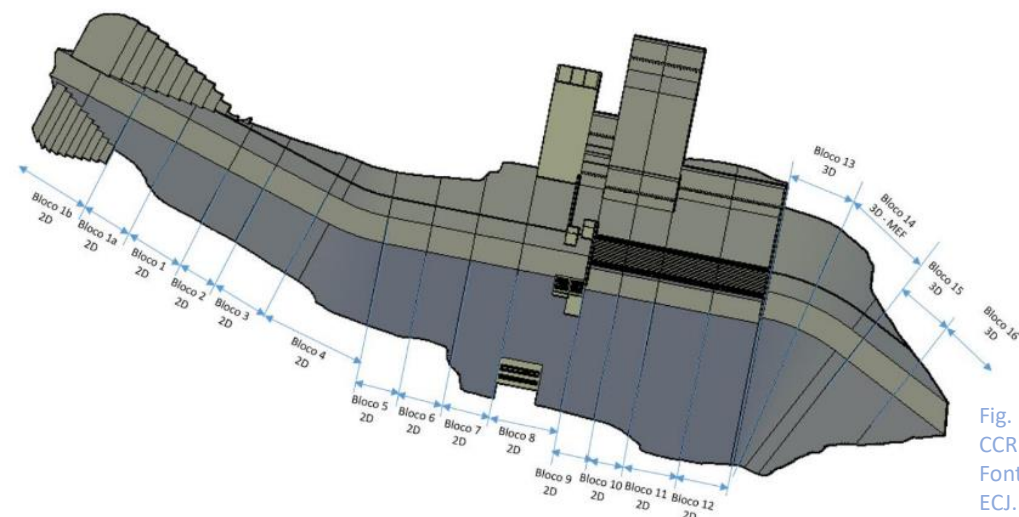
Planta dos blocos de concreto CCR da ECJ.
